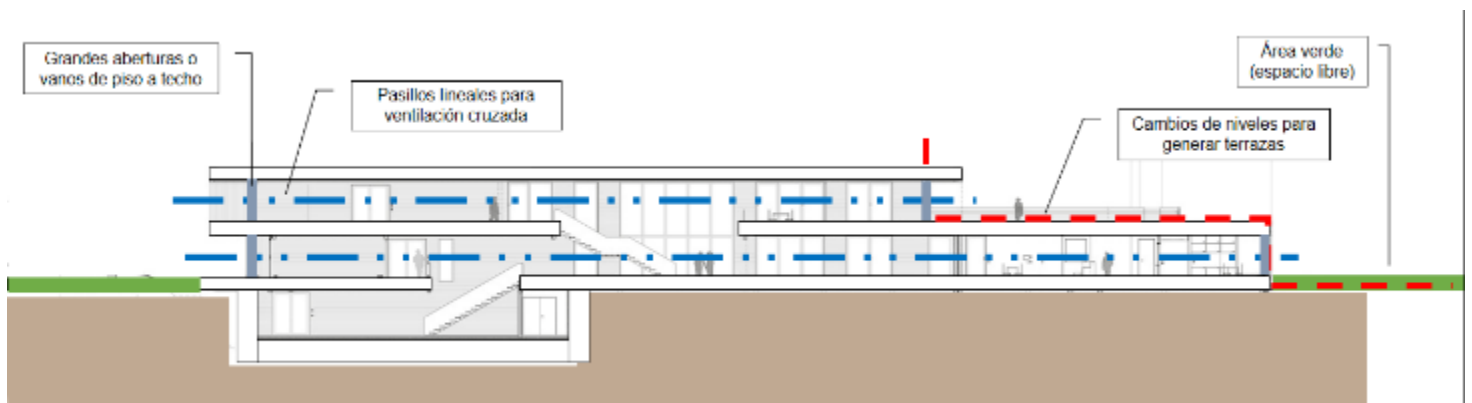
Boceto de planta arquitectónica caso 6. Fuente: Elaboración propia
